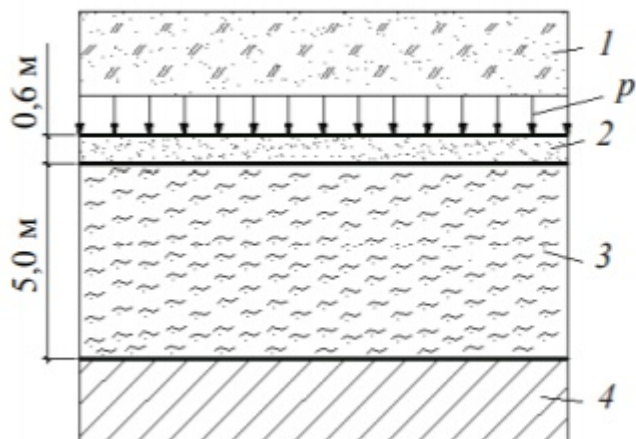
Схема к расчету осадки слоя грунта для примера 2.1: 1 – пригрузочная насыпь; 2 – фильтрующая песчаная подушка; 3 – слабый водонасыщенный слой; 4 – водоупорный слой
